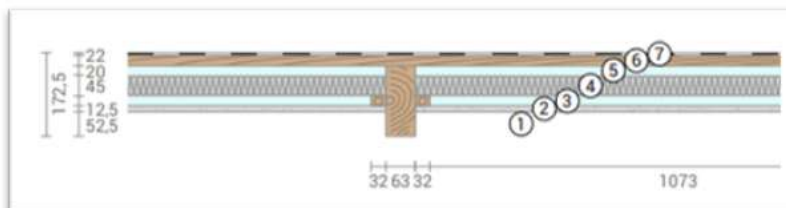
P06 Plat dak met ALU Seal 90 tussen de balkconstructie
